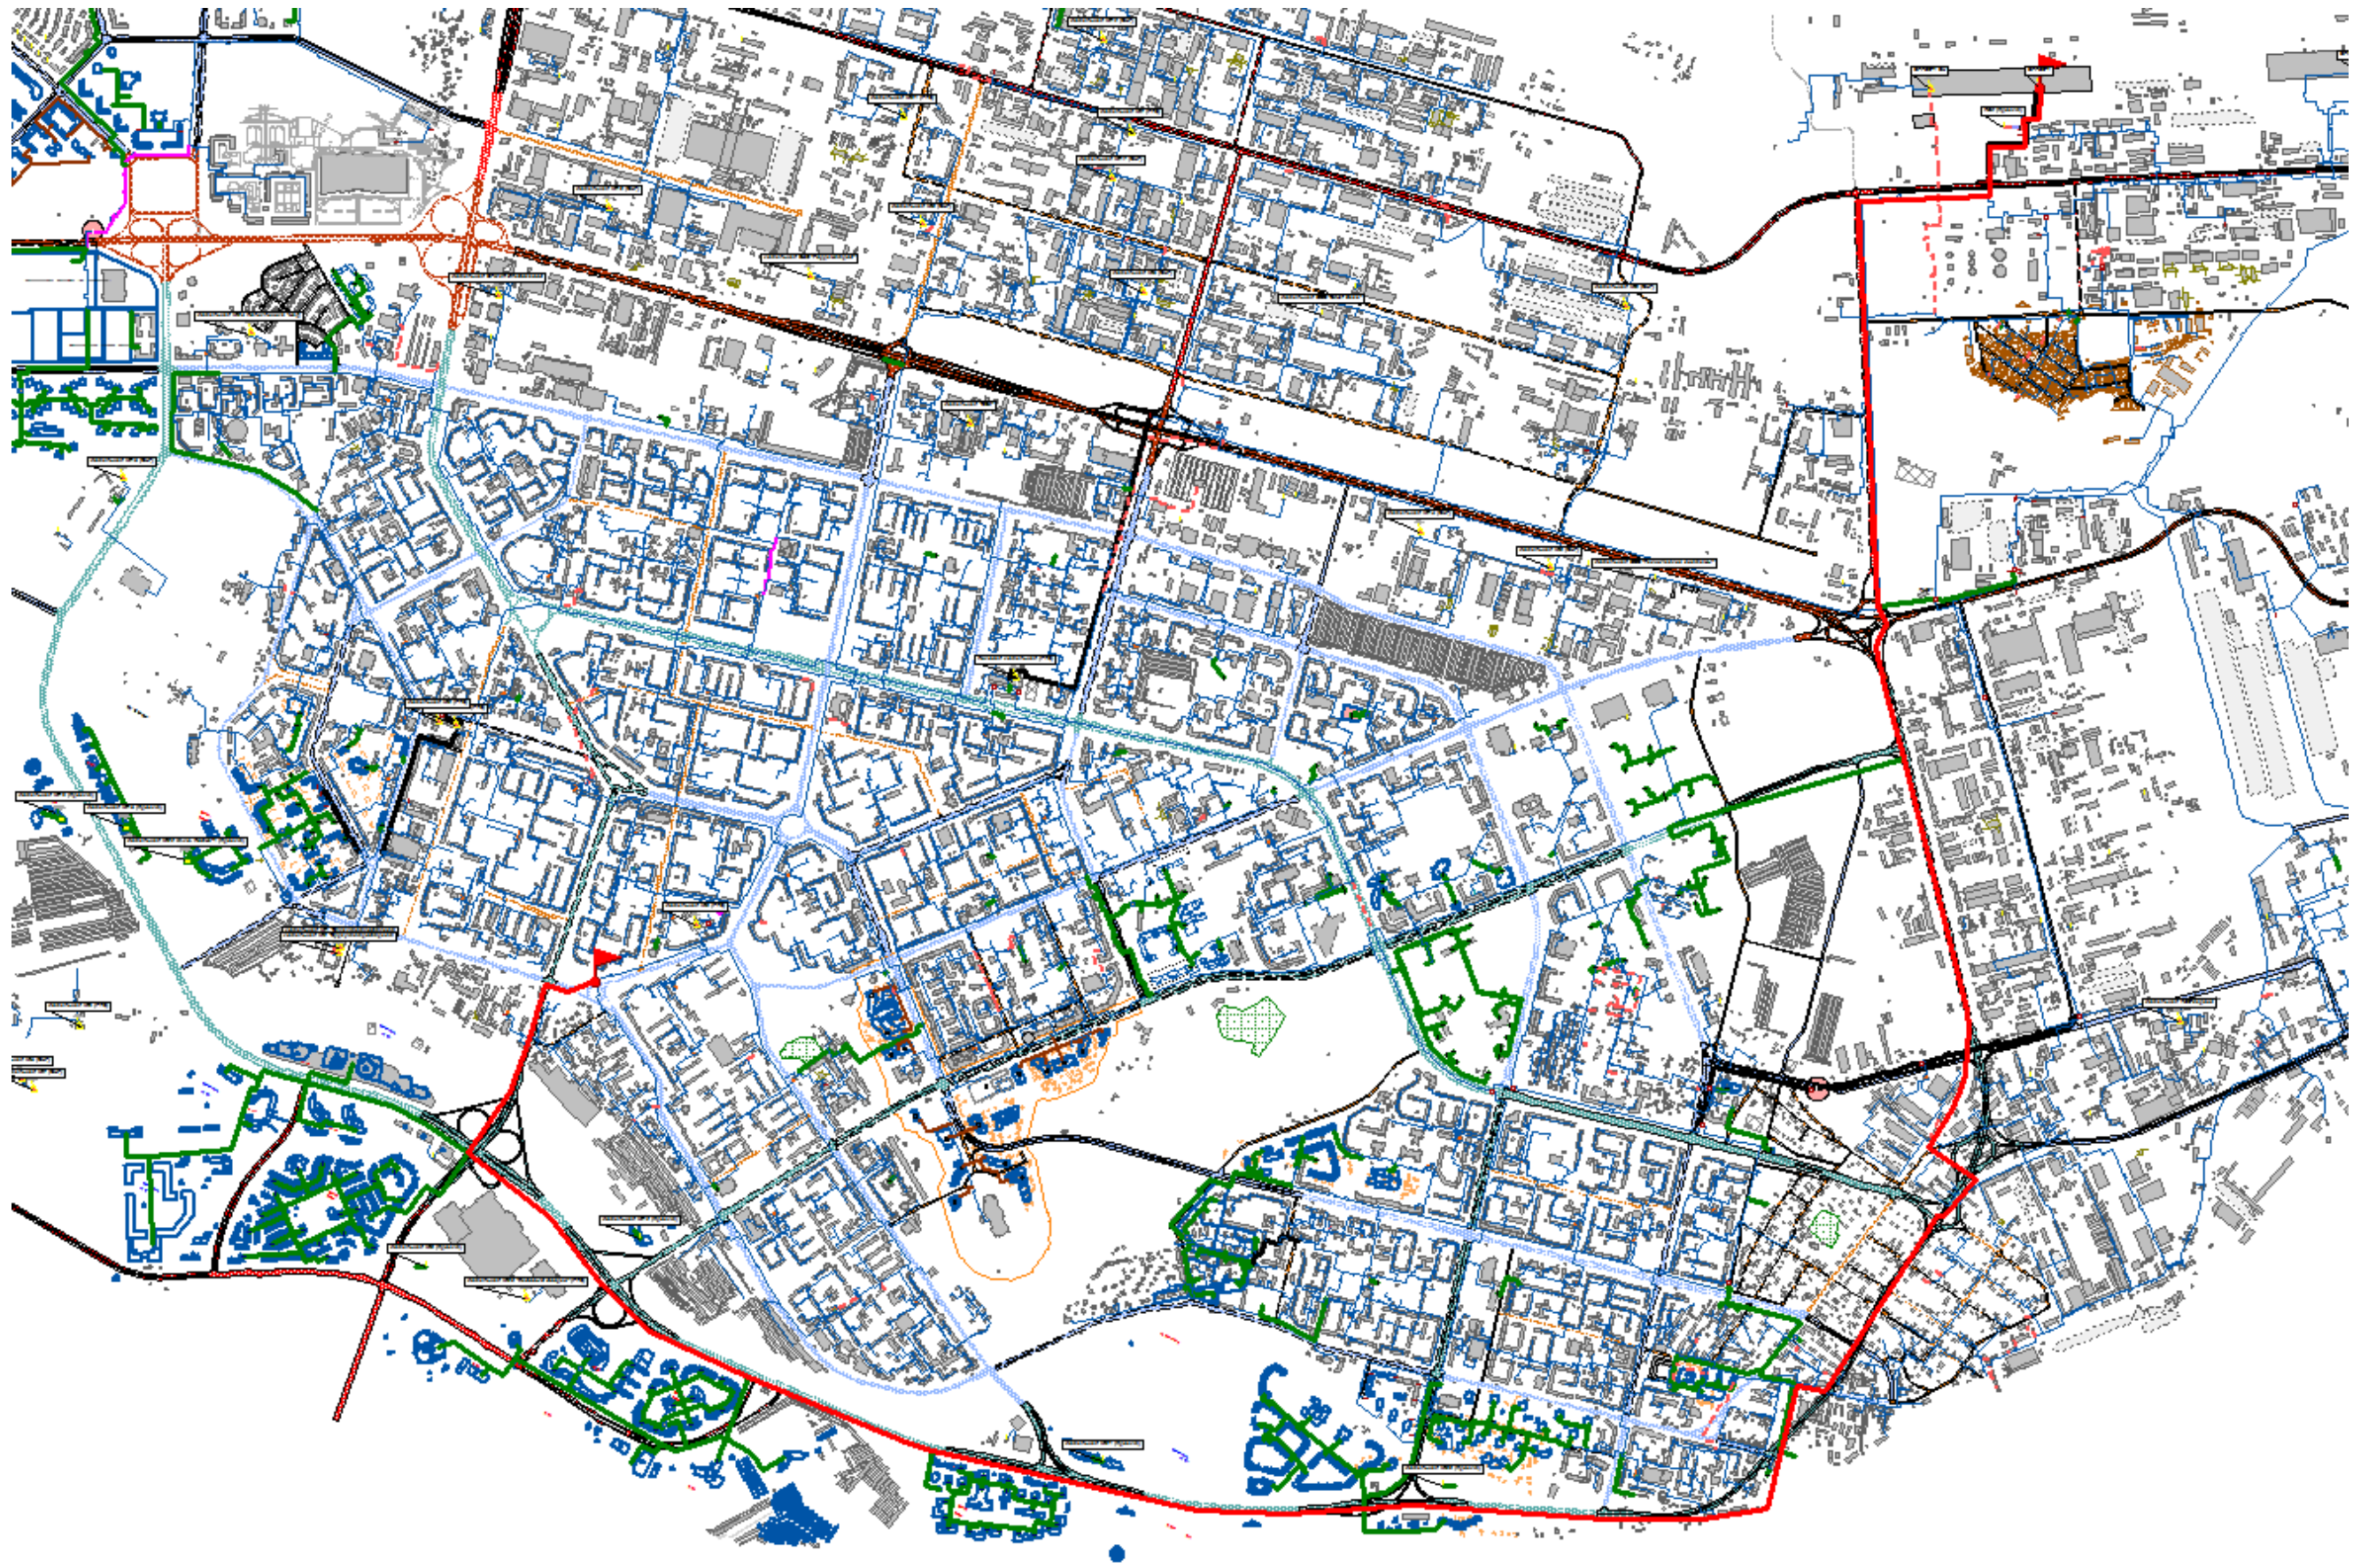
План-схема развития систем теплоснабжения по варианту №1
